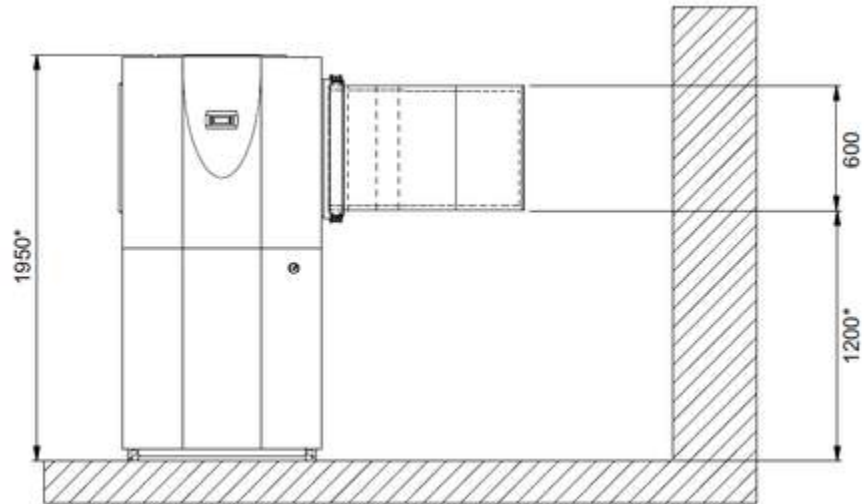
Vue de face - LIK 12TU (installation murale avec gaine d'air côté refoulement)
